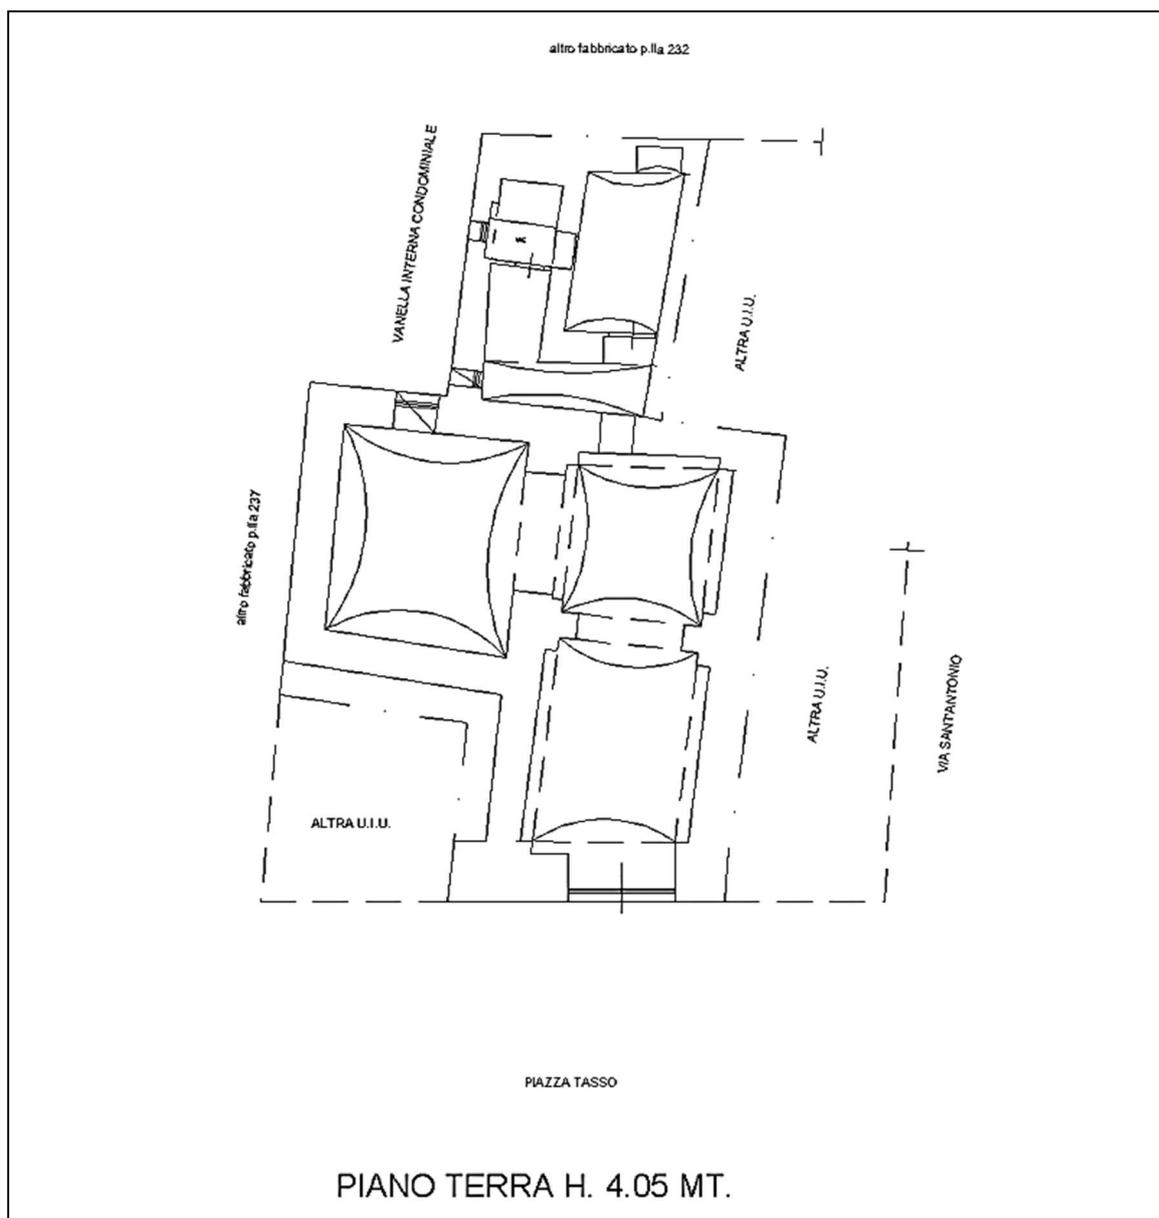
Planimetria catastale del lotto 1 (locale commerciale)
